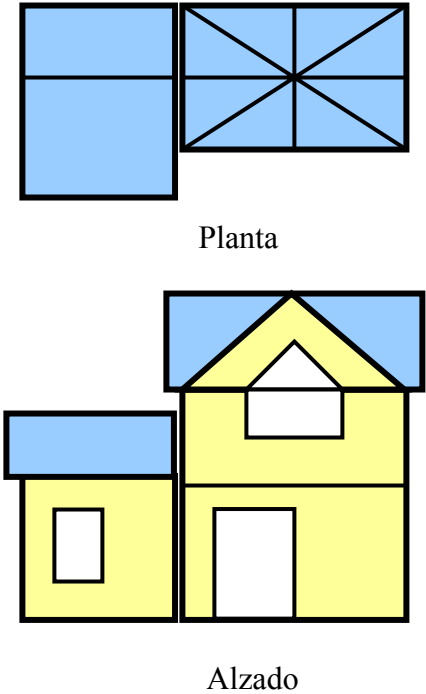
Vista en planta y alzado de configuraciones arquitectónicas irregulares en viviendas
